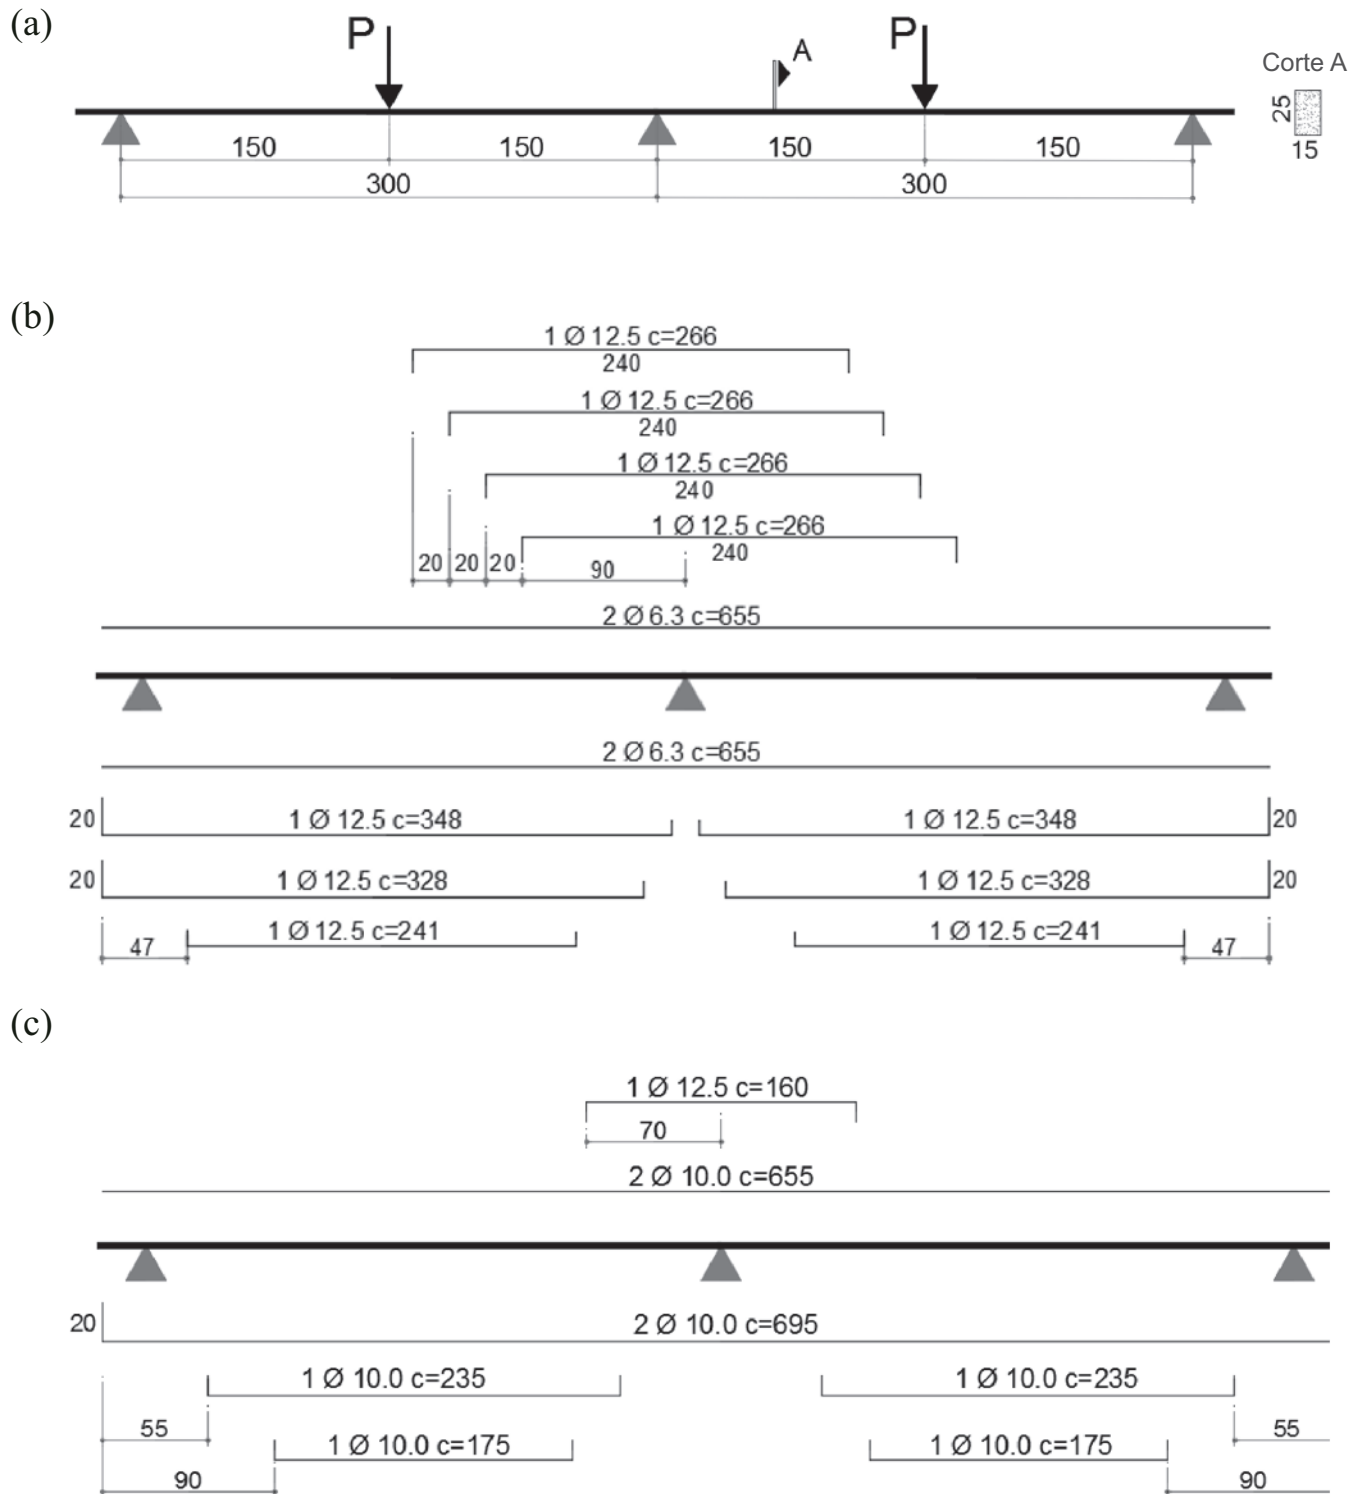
Vigas ensaiadas por Silva (15): a) geometria e carregamento; b) detalhamento das armaduras longitudinais da viga V1; c) detalhamento das armaduras longitudinais da viga V3 (medidas em cm)
